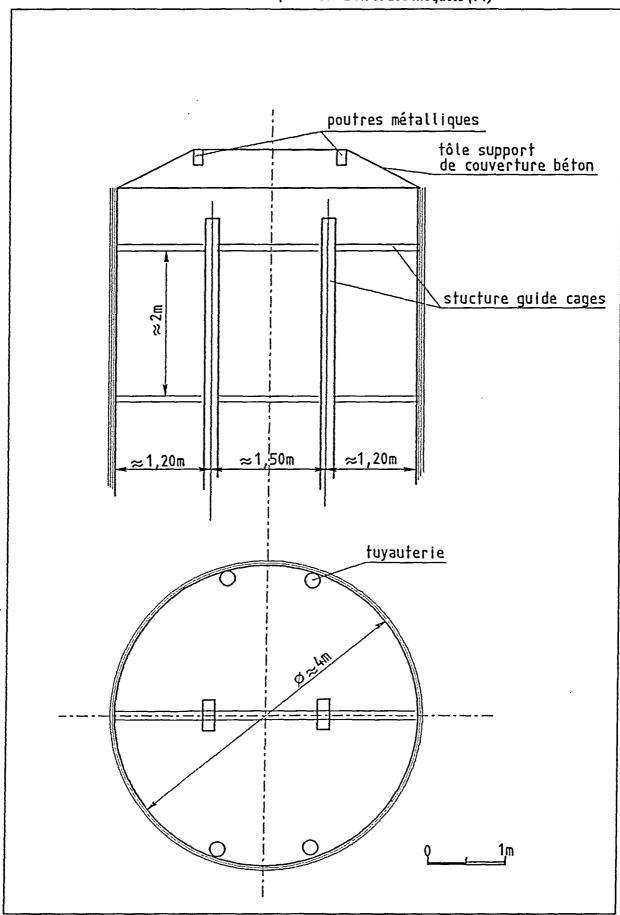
Intérieur du puits 9 : section et coupe longitudinale
